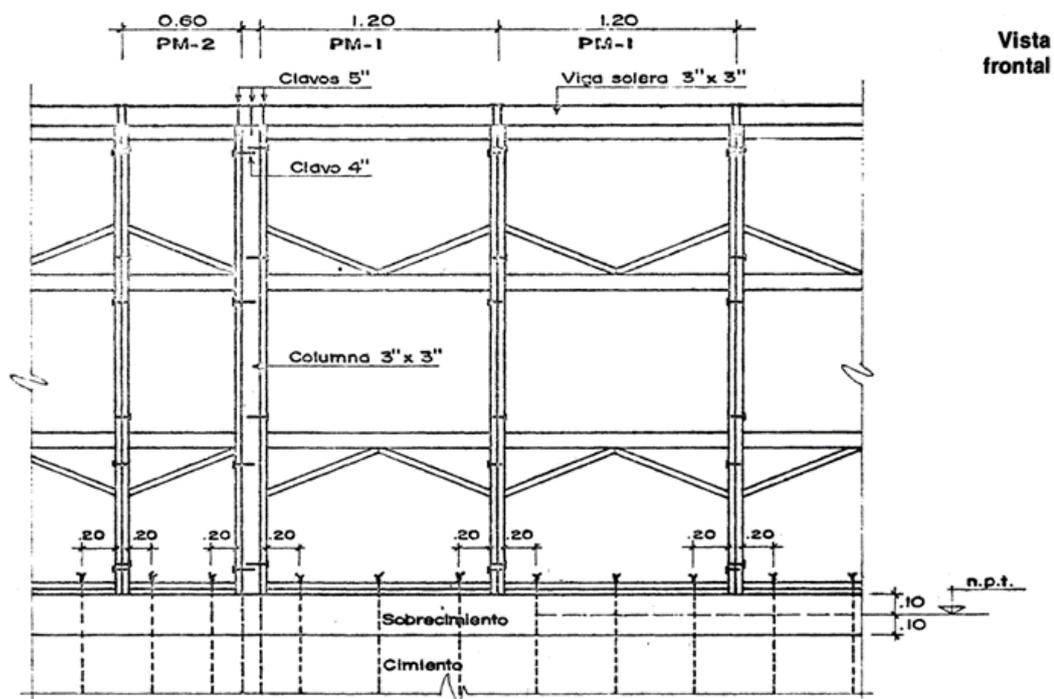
Fijación paneles entre sí, a columnas, a cimentación y a viga solera.
